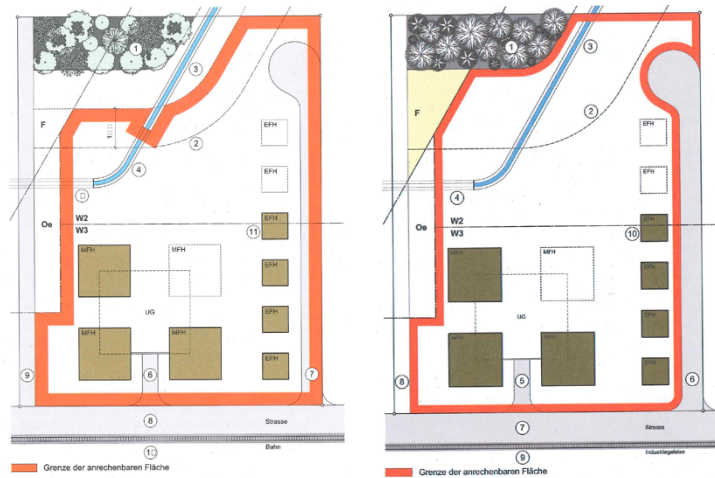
massgebliche Grundfläche, Darstellung gemäss «Zürcher Planungs- und Baurecht» Fritzsche, Bösch, Wipf, Kunz, 2019
